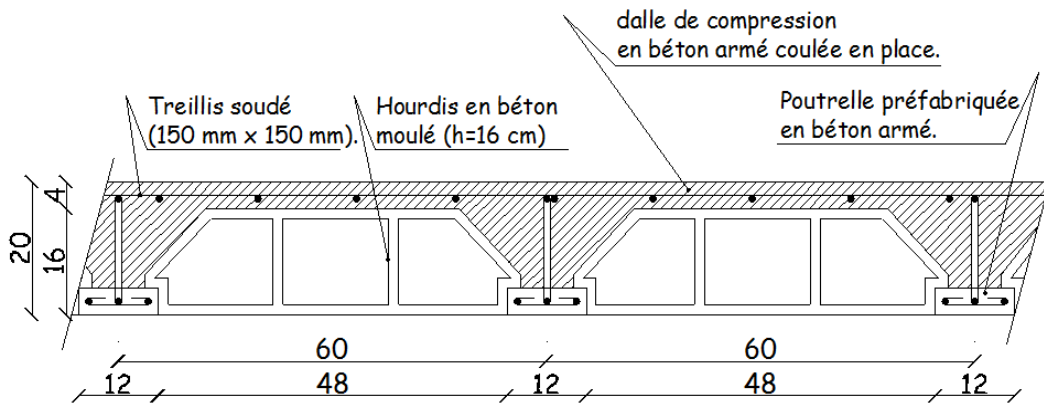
Plancher en béton armé avec poutrelles et hourdis (Plancher semi préfabriqué).
